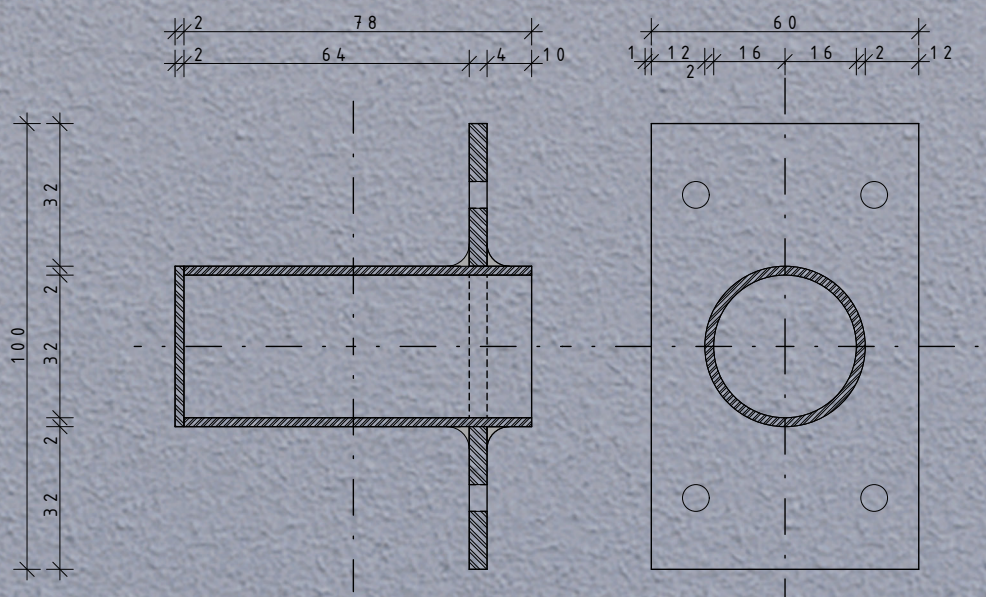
DETAIL HORNÍHO UCHYCENÍ - M 1:2
